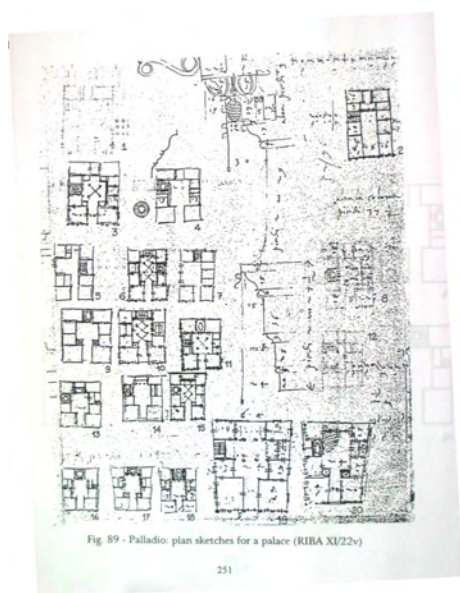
Plantas de Palladio, estudo para um palácio. RIBA XV/22v - Fonte: Pereira (1998).
